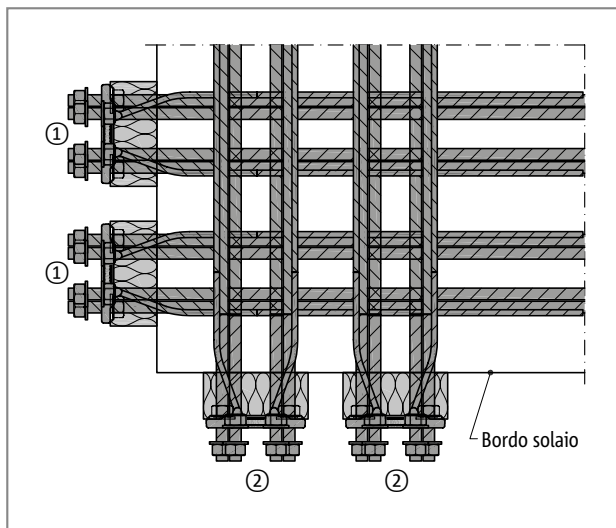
Schöck Isokorb® T tipo SK: angolo esterno
